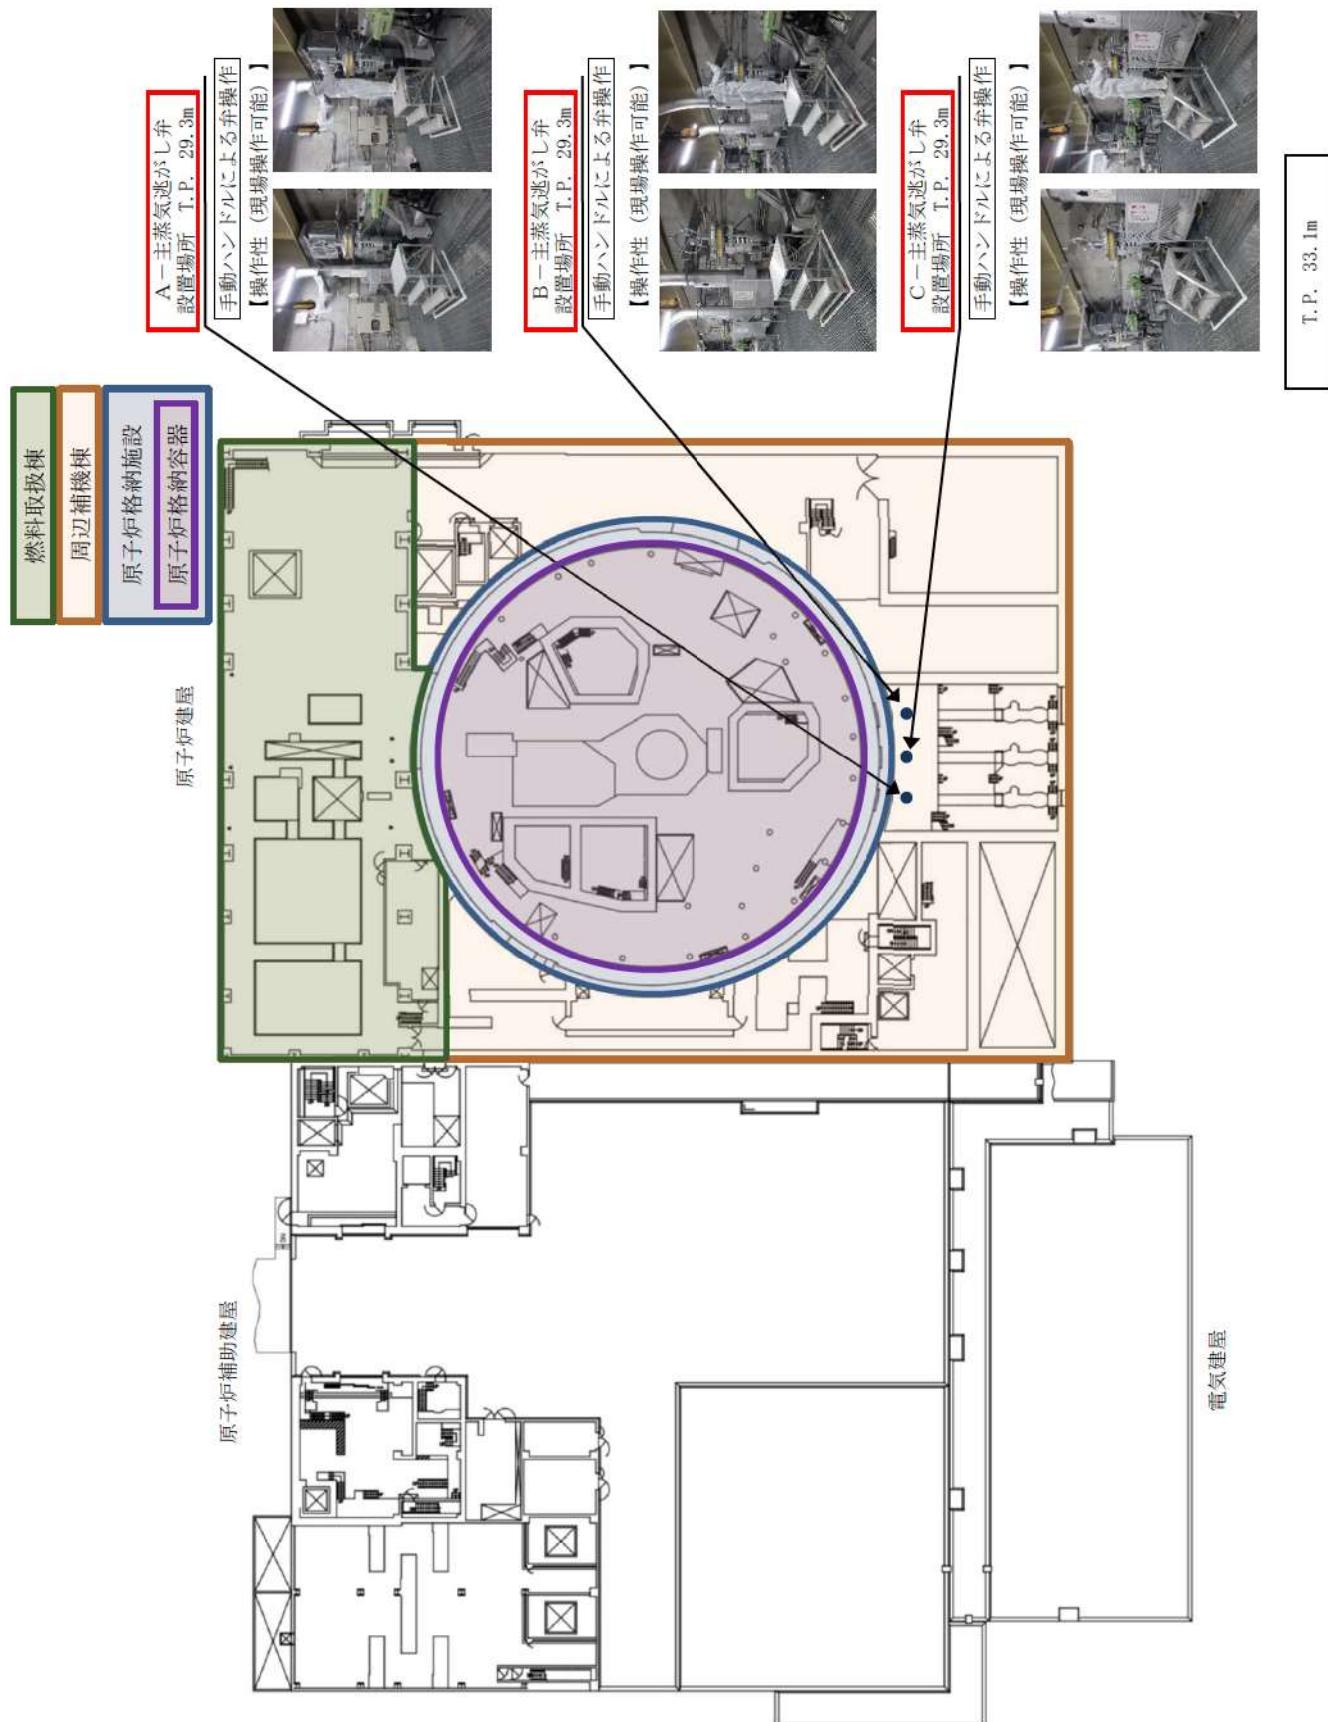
7 - 2 - 6 配置図 (T. P. 33. 1 m)
